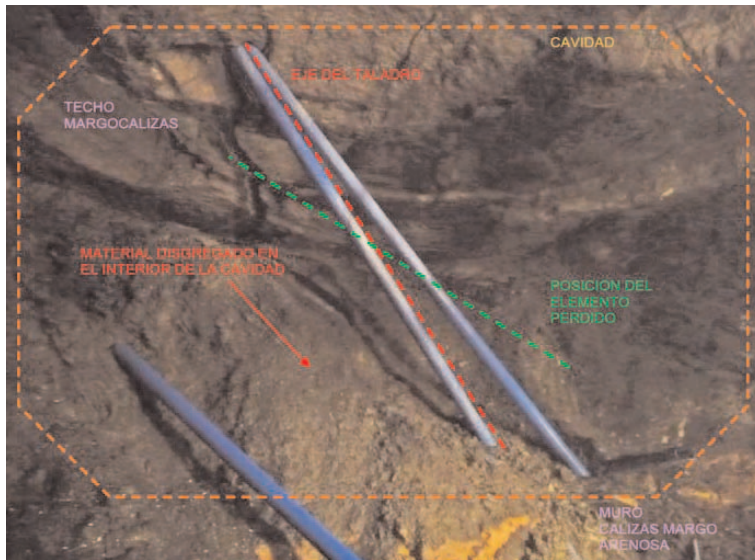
Detalle de la marga gris laminada, donde quedó atrapada la batería drillcon, en la galería auxiliar.
